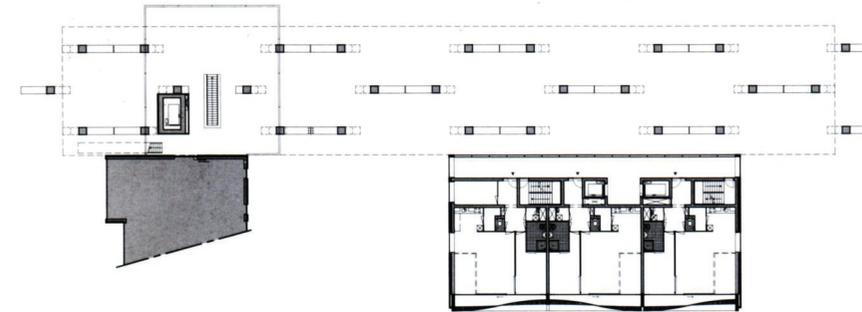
Grundriss 1. Obergeschoss M 1:1250
